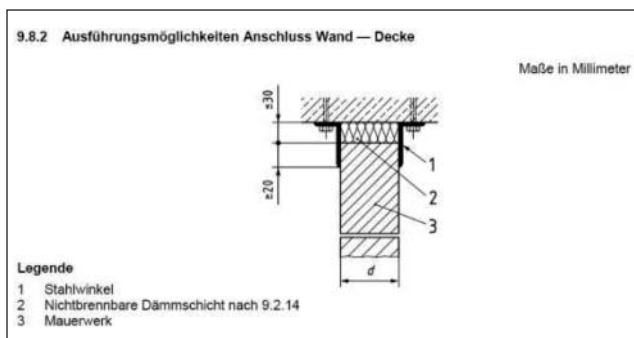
Korrekter Deckenanschluss nach DIN 4102-4:2016-05 (Kap. 9.8.2, Bild 9.1)
